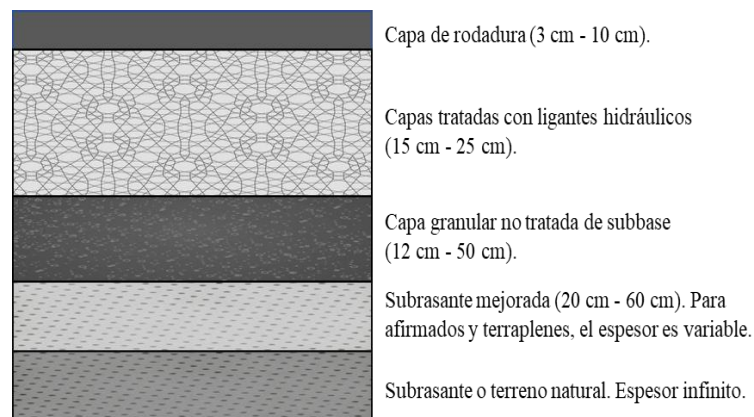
Perfil típico de una estructura de pavimento semirrígida
